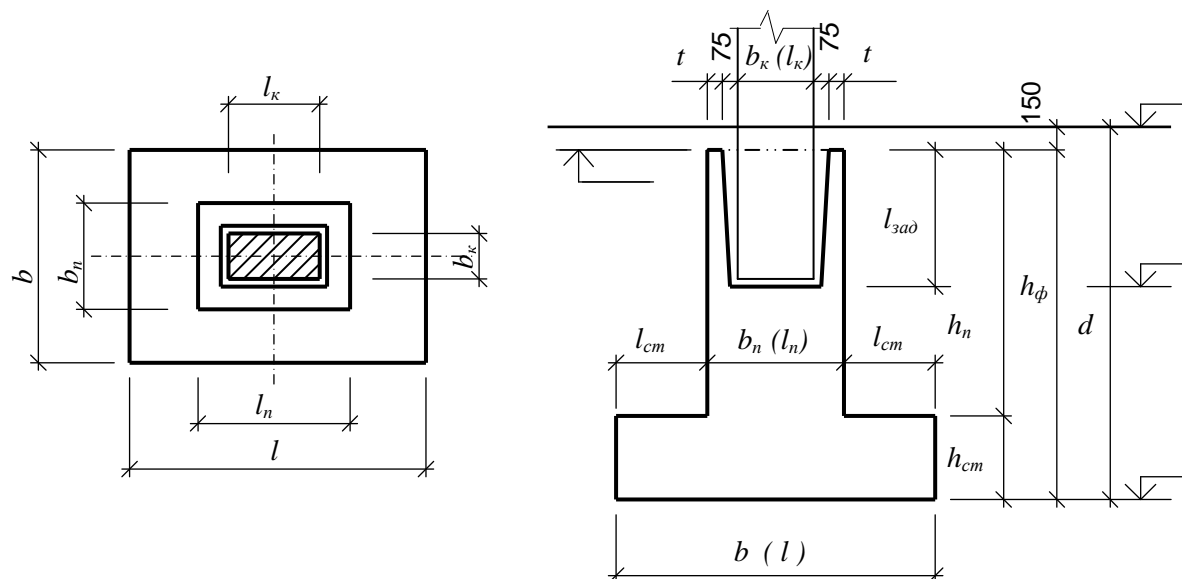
К конструированию отдельного монолитного железобетонного фундамента под сборную железобетонную колонну
